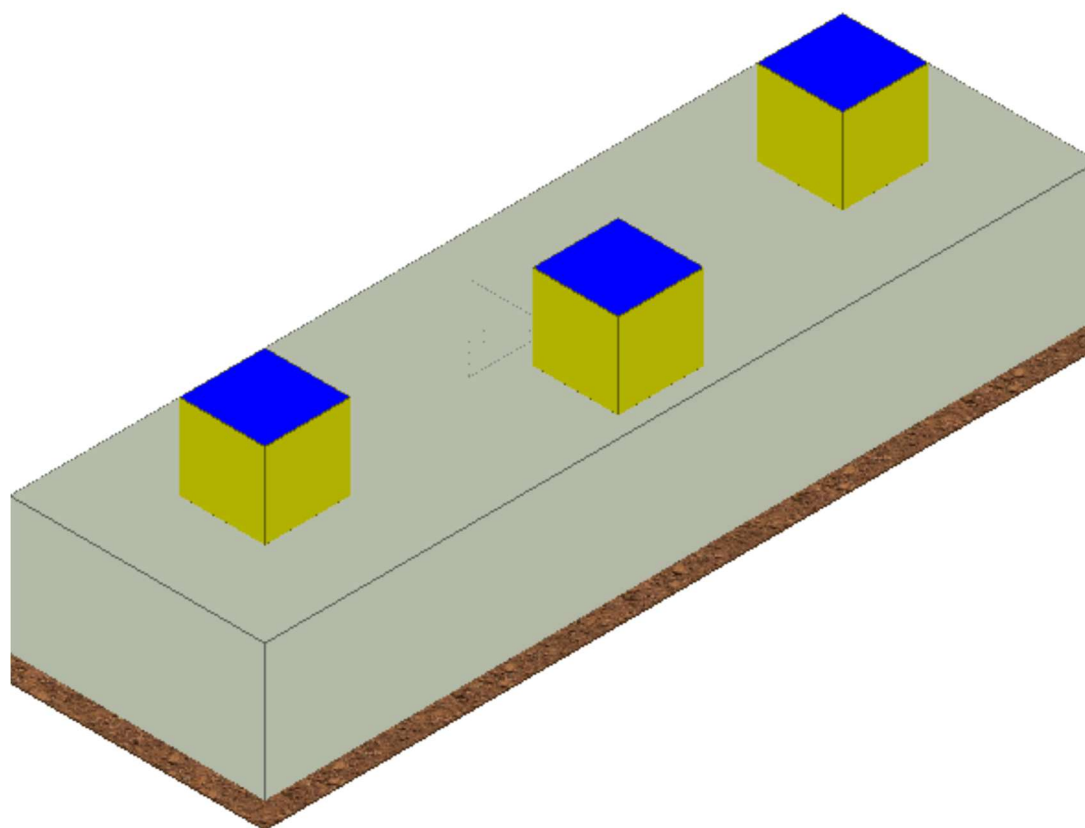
vista tridimensionale della fondazione del SEZIONATORE ORIZZONATLE AT, CON LAME DI MESSA A TERRA
